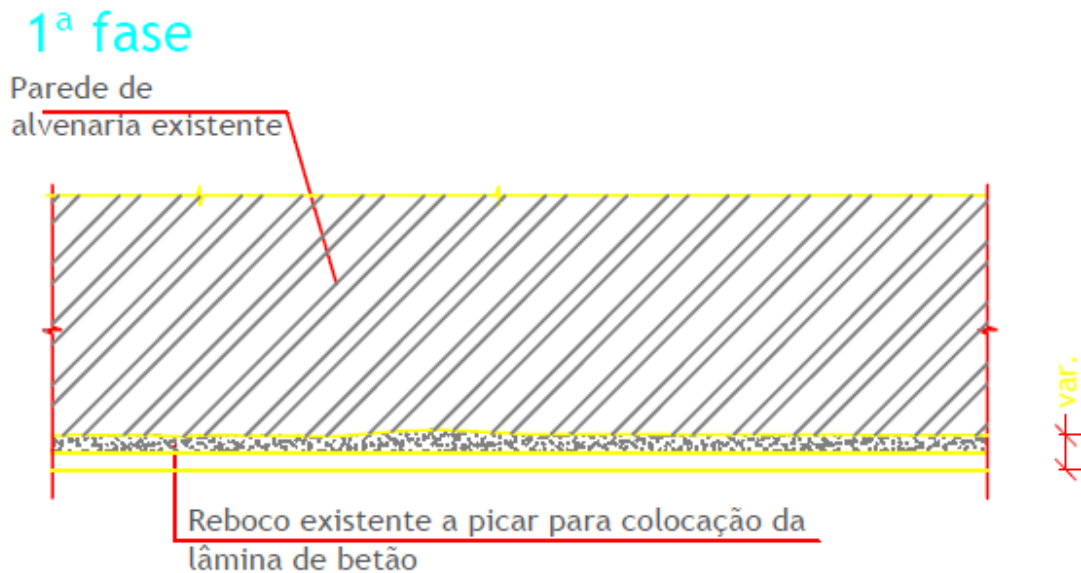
Primeira fase descrita em projeto sobre a aplicação de lâminas de betão sobre paredes de alvenaria existentes
